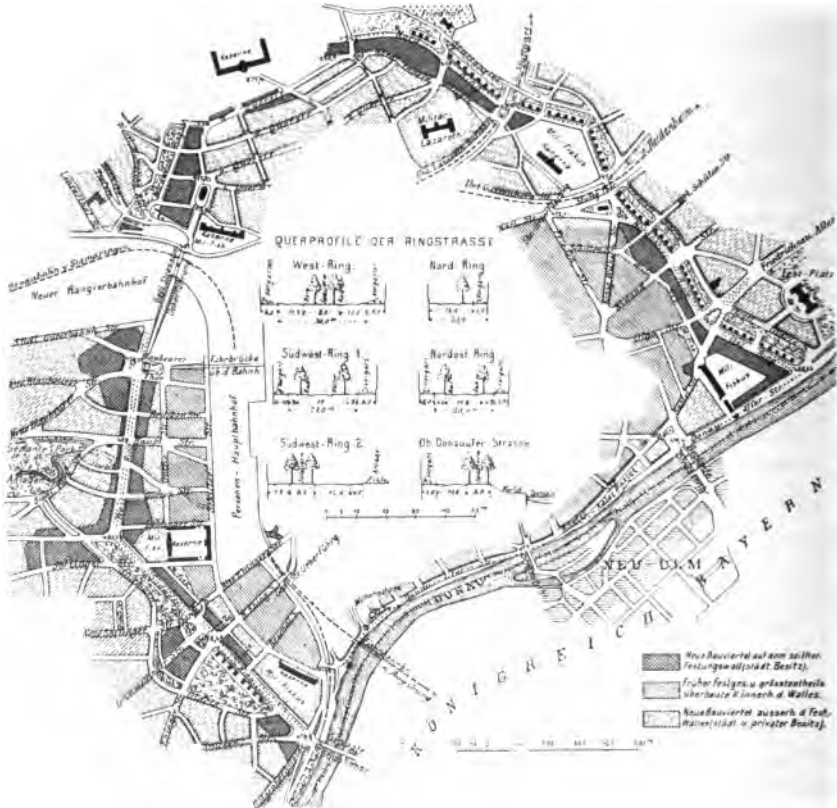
Ringstrassen-Anlage der Stadt Ulm.
